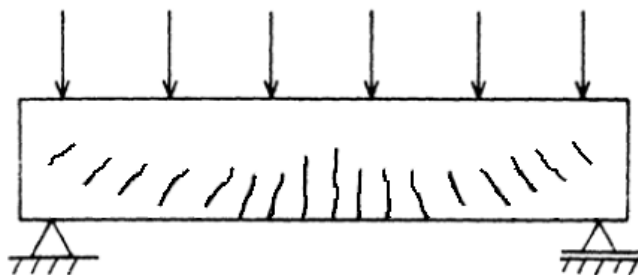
Fissuração típica de uma viga isostática solicitada à flexão
